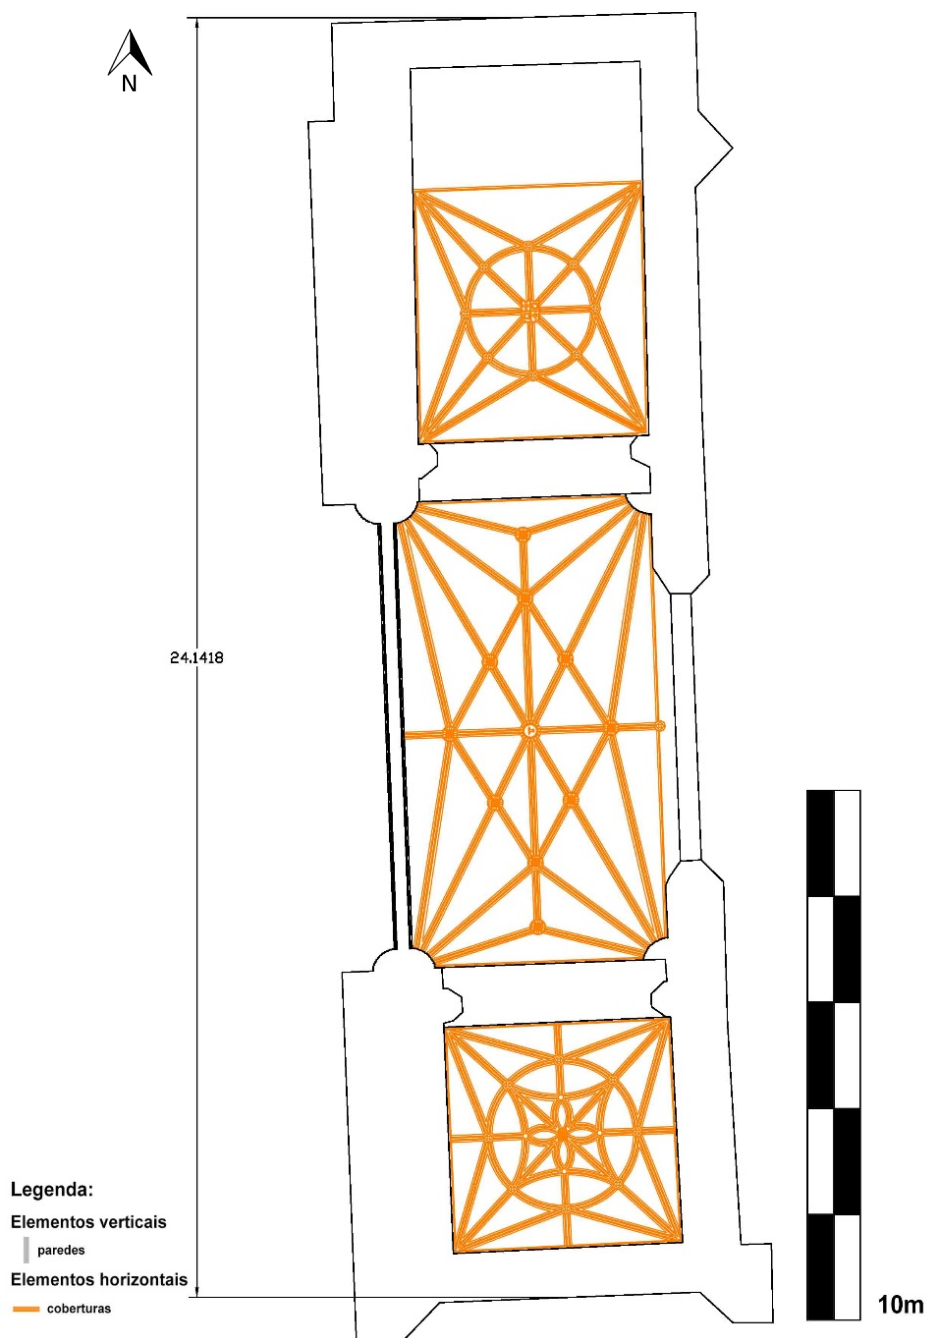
Planta do teto do transepto com o levantamento das abóbadas. Fonte do levantamento: DRCN/Gabinete T.A.M.
